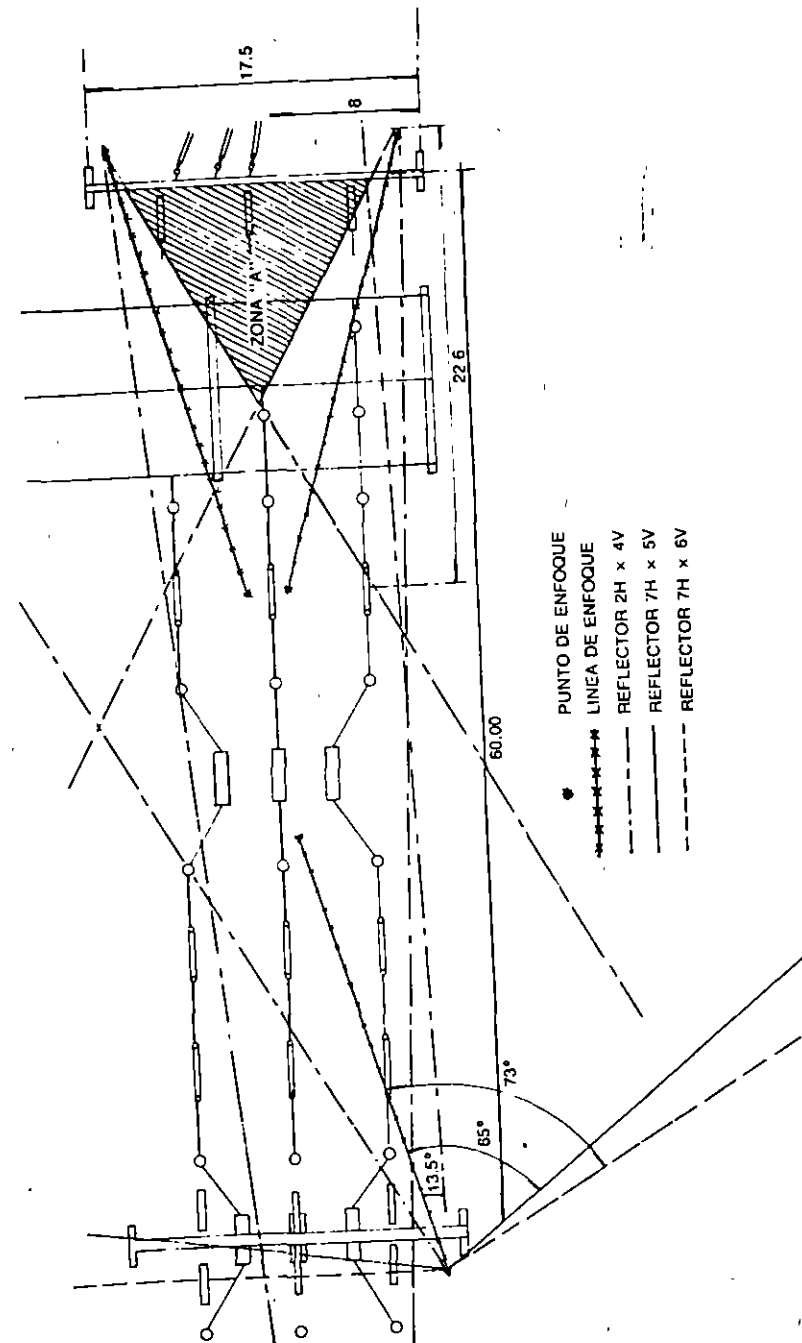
Vista de planta de los haces horizontales de los tres reflectores (1/2 módulo de 230 kV)
